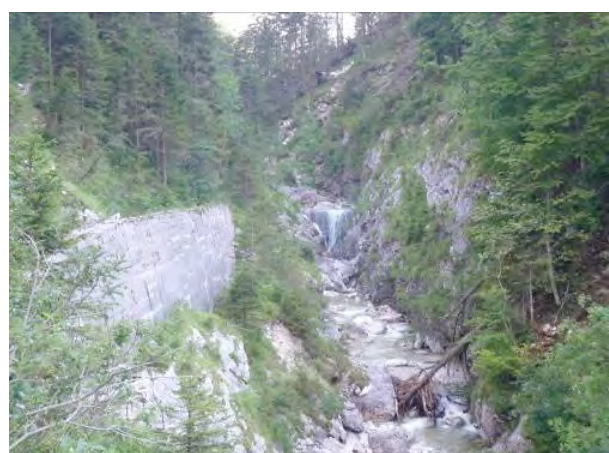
Links Betonmauer, im Hintergrund Querbauwerk des Klausbetriebs, flussaufwärts
